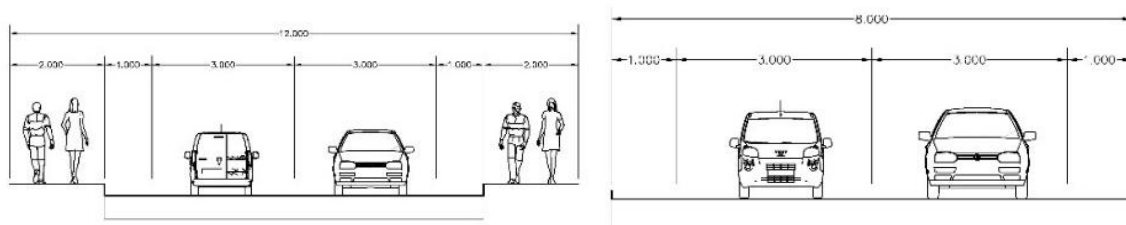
Visão geral das secções transversais de corredores de menor dimensão (12-8 metros)
